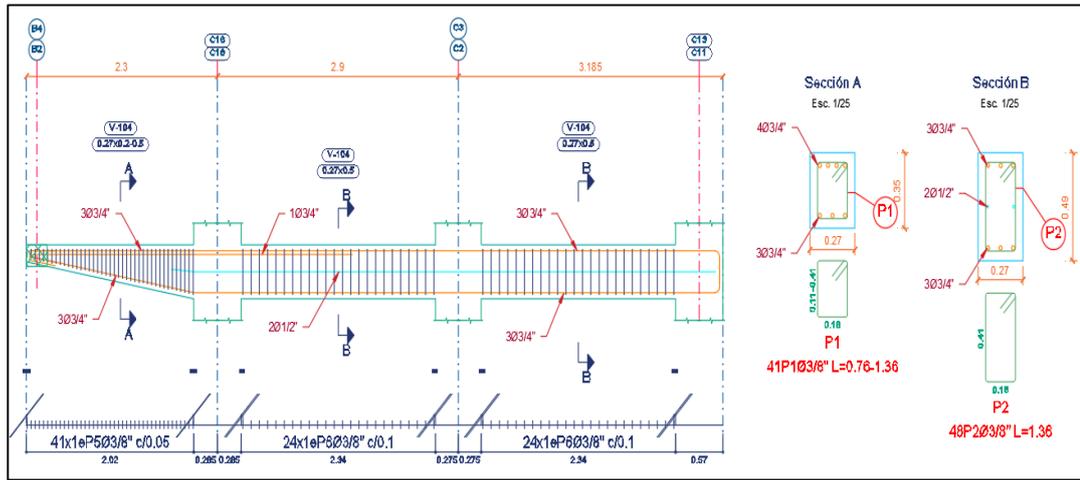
VIGA EN LA DIRECCION Y-Y EJES 4-4 Y 6-6
